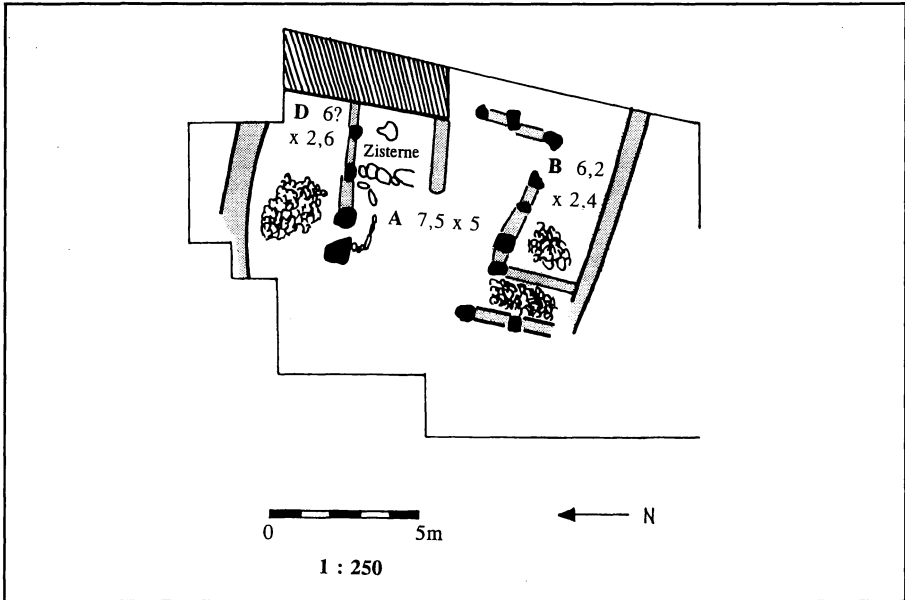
Hirbet Sēlūn: Grundriß nördliches Gebäude
